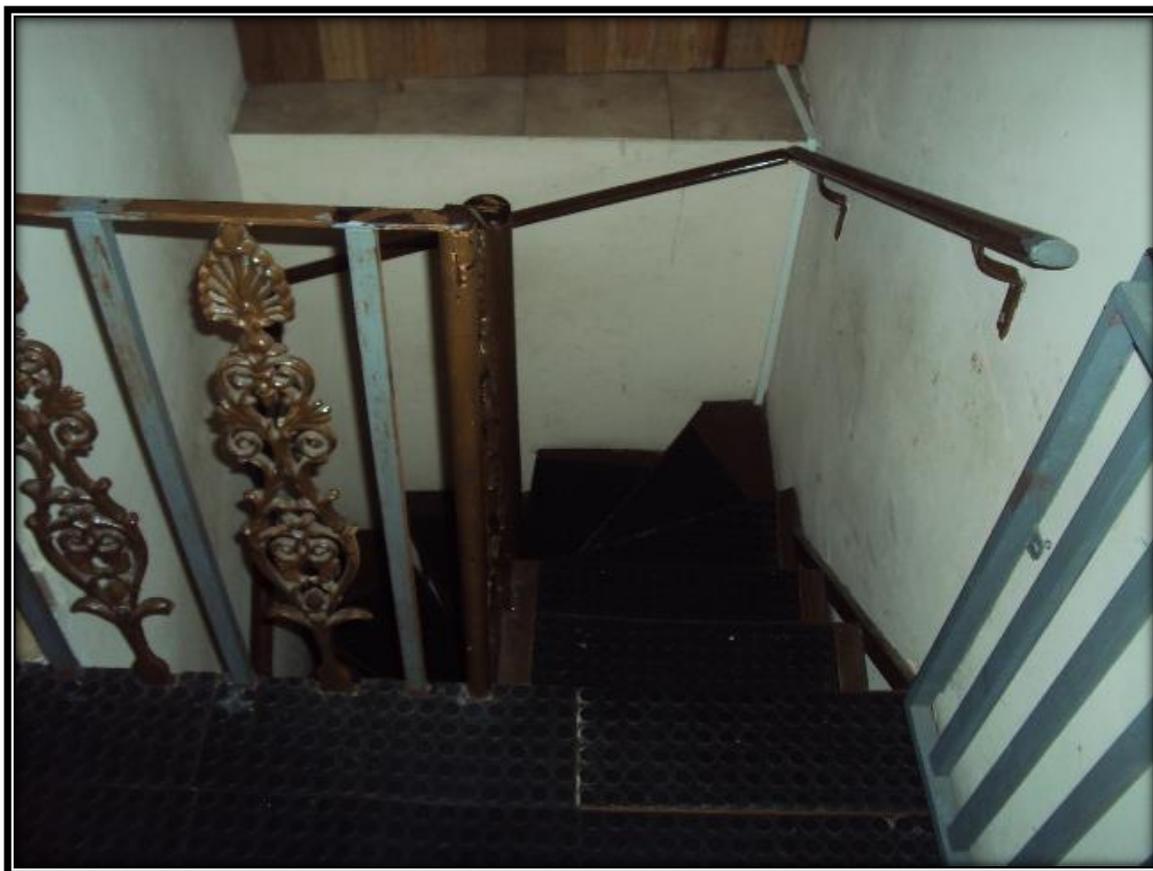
Outra vista da escada de acesso ao apartamento do andar superior.
